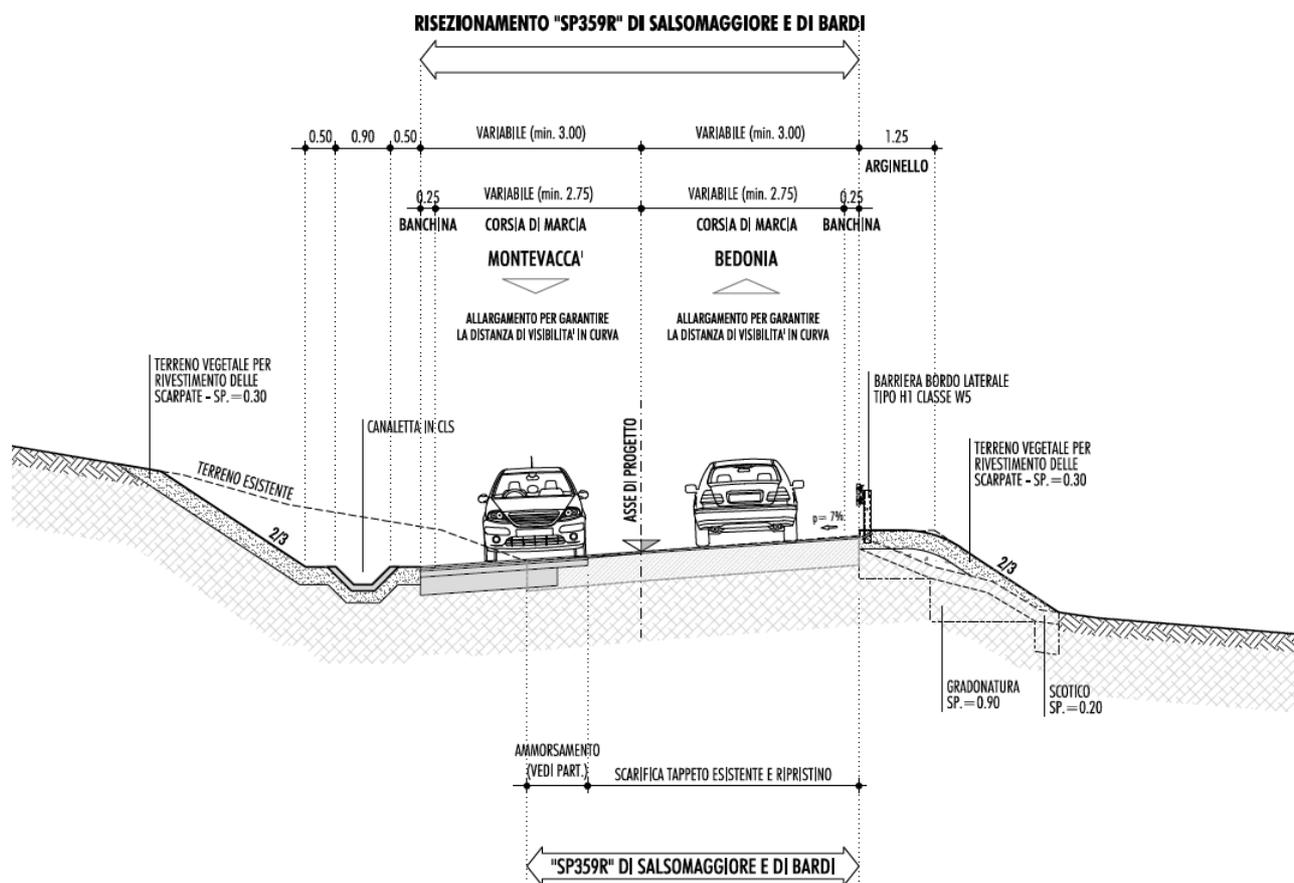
SEZIONE TIPO TRATTO 2 A “MEZZACOSTA”
